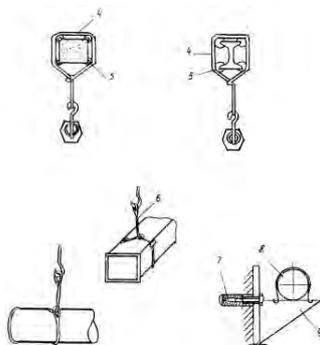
Стрповка воздуховодов круглого и прямоугольного сечения
